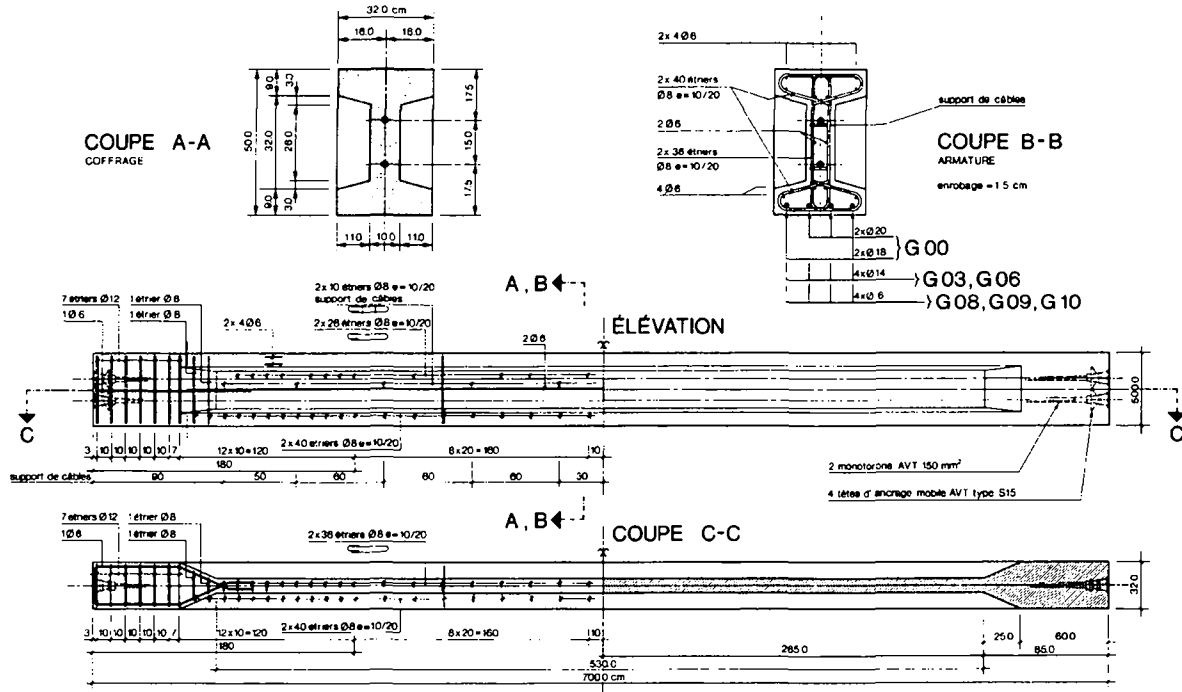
Poutres précontraintes testées par Rotilio [63]
